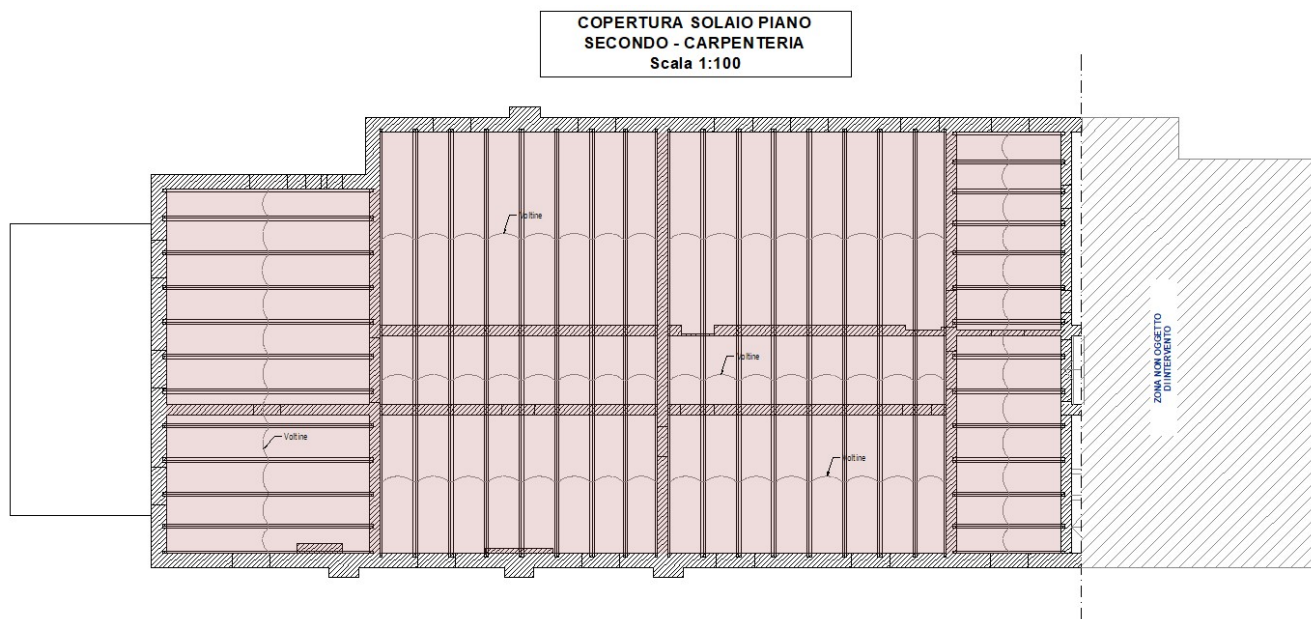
Carpenteria di progetto – solaio di copertura piano secondo
